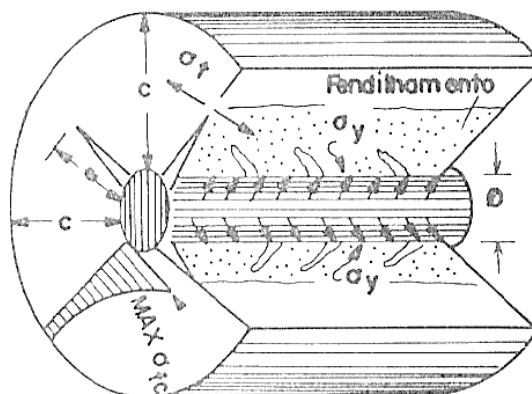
Diagrama esquemático da deformação do concreto ao redor da barra após a formação das fissuras internas causadas por tensões principais de tração (GOTO, 1971).
